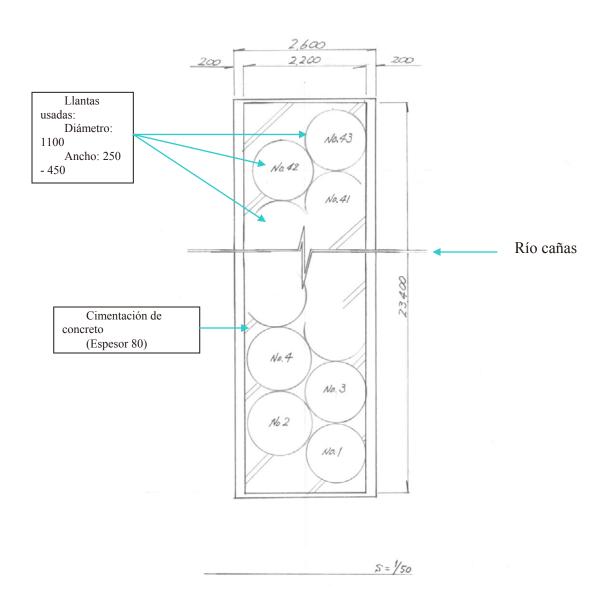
Planos de un dique levantado con las llantas usadas (planta)
